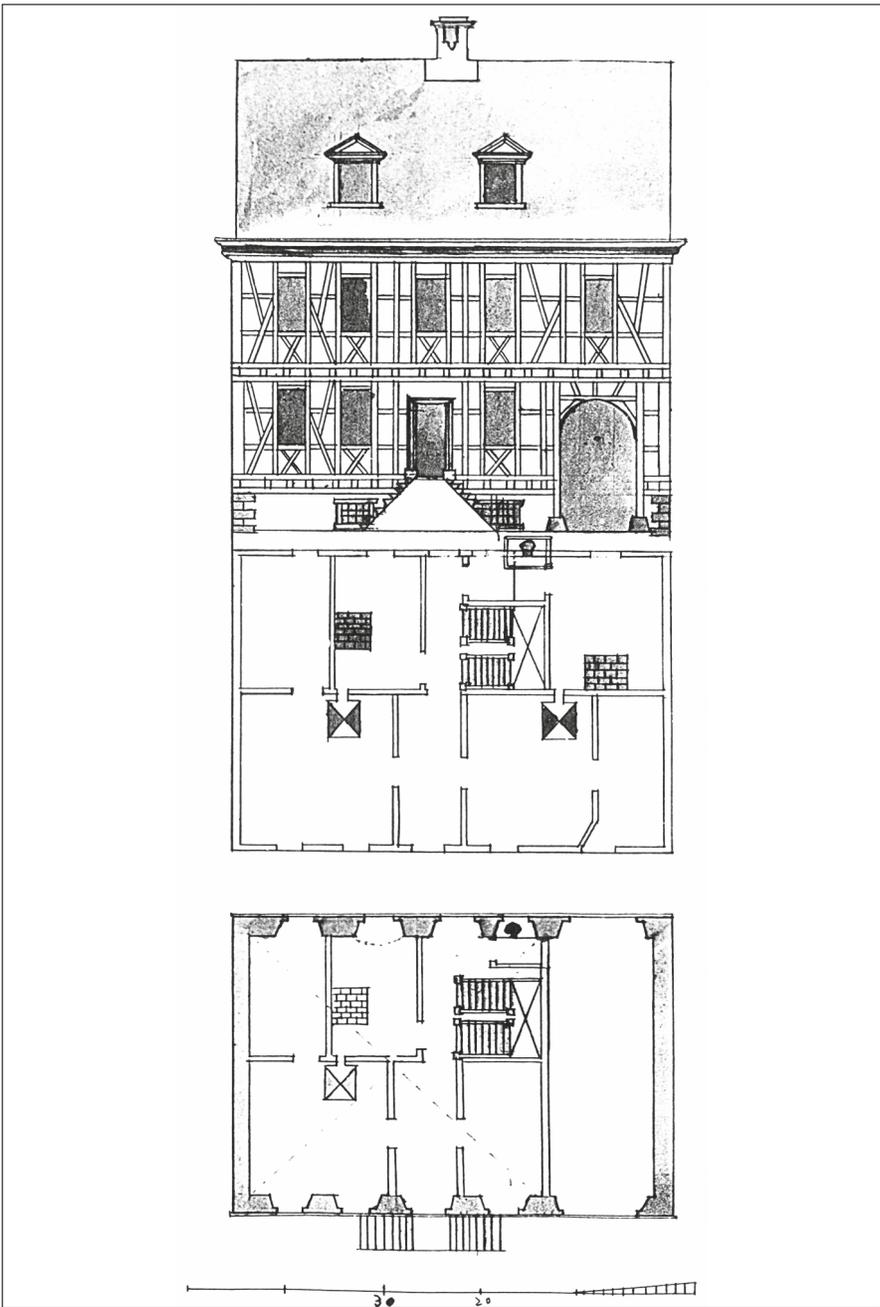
Plan Nr. 16, typisch für Zeichner »C«, Doppelhaus mit getrennten Eingängen, gebrochenes Dach, Wohnung mit drei Räumen, Durchfahrt, Freitrepp, die Haus-Grundform ist grau unterlegt, geplant 1767.
